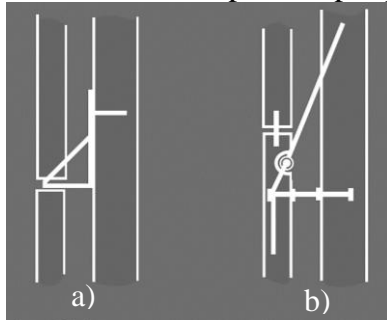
Anclaje de muros de fachadas contra fuerzas horizontales, a) insuficiente, b) correcto (Bachmann, 2003).
